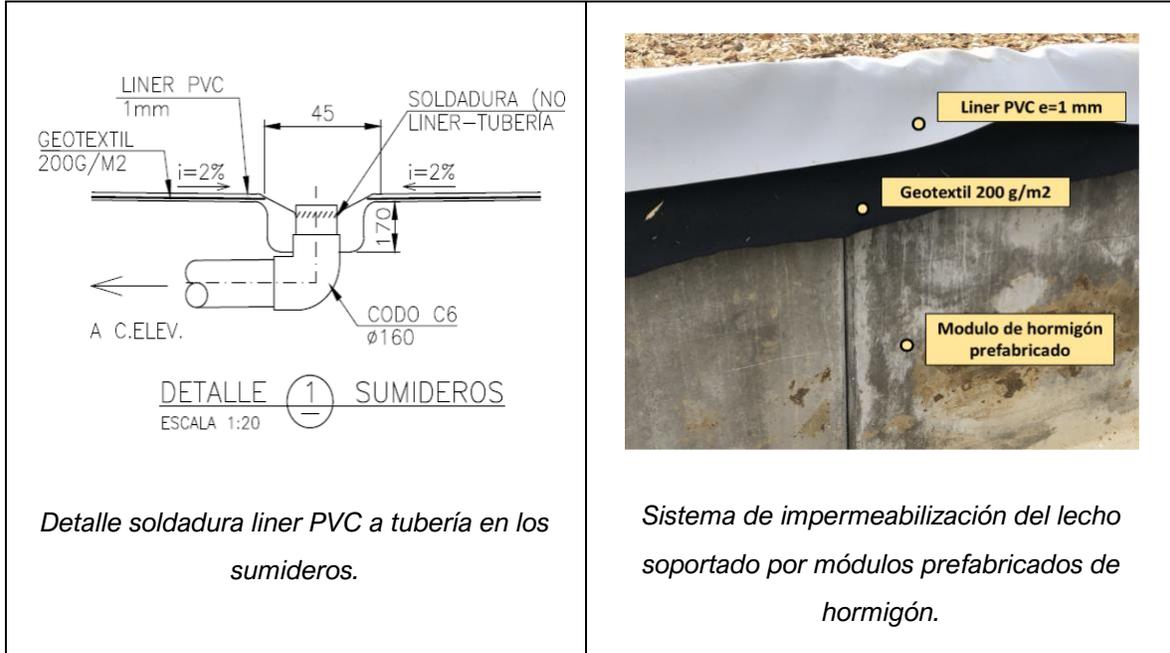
Obra civil biofiltro dinámico aeróbico construido con módulos prefabricados de hormigón recubierto con película impermeable.
